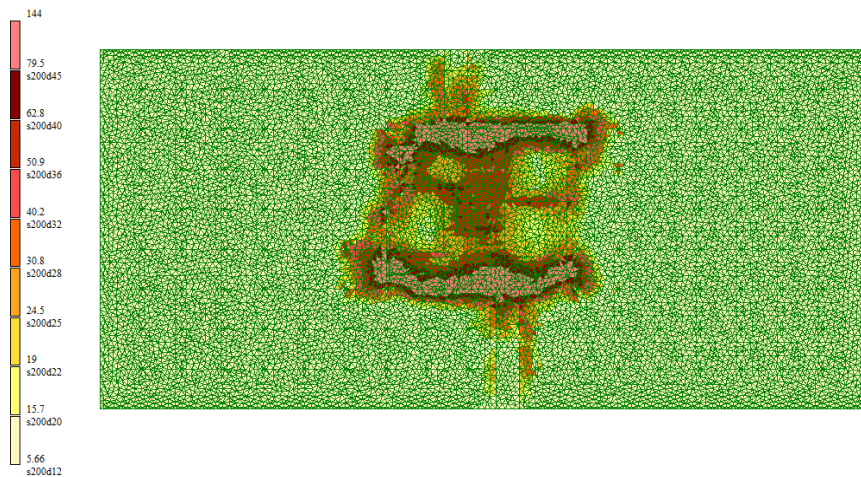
Схема армирования фундаментной плиты по оси Y (у нижней грани)
